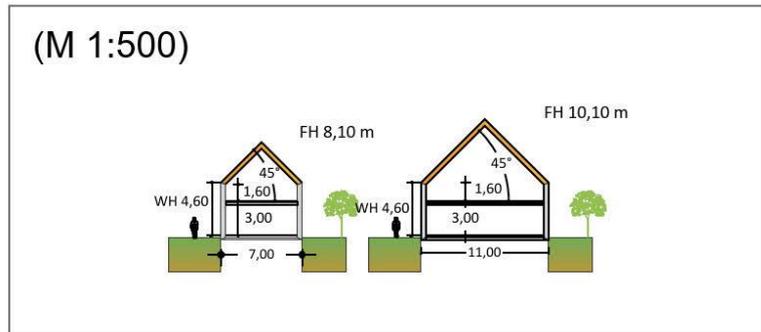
skizzenhafte Darstellung der Haustypen Typ A, jeweils nur mit Satteldach und einer Dachneigung von 30°-45° zulässig
